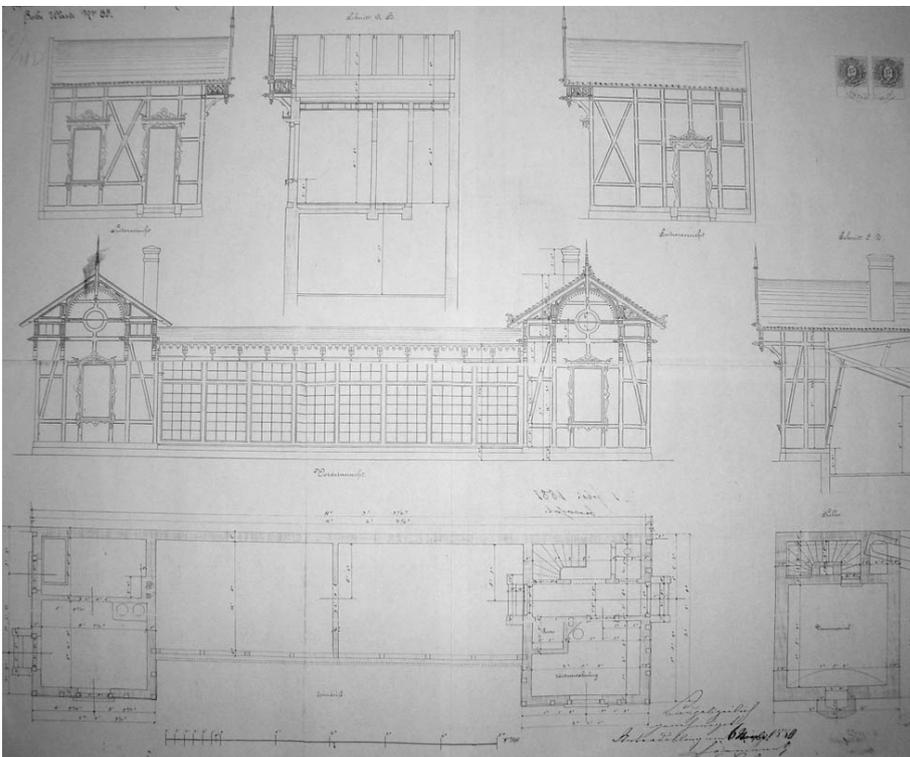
Villa Rittershausen. Plan für ein Glashaus. 1880. Einreichplan.
